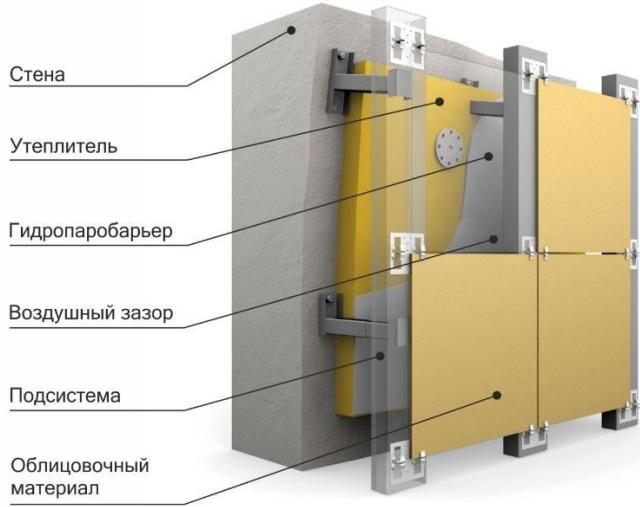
Общий вид системы с вентилируемым фасадом
